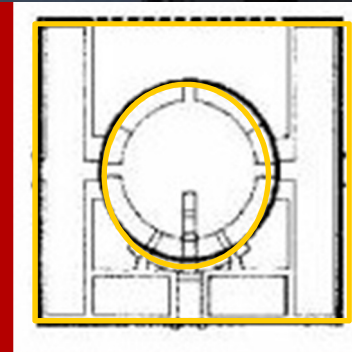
e 136: Santa Maria degli Angeli (Filippo Brunelleschi, 1434)
